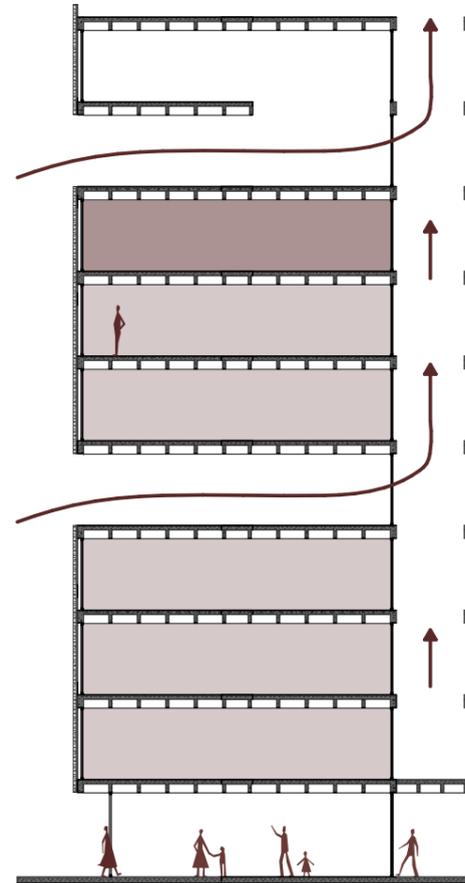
Sección A - A - Terrazas intermedias. Fuente: Autoría propia.
